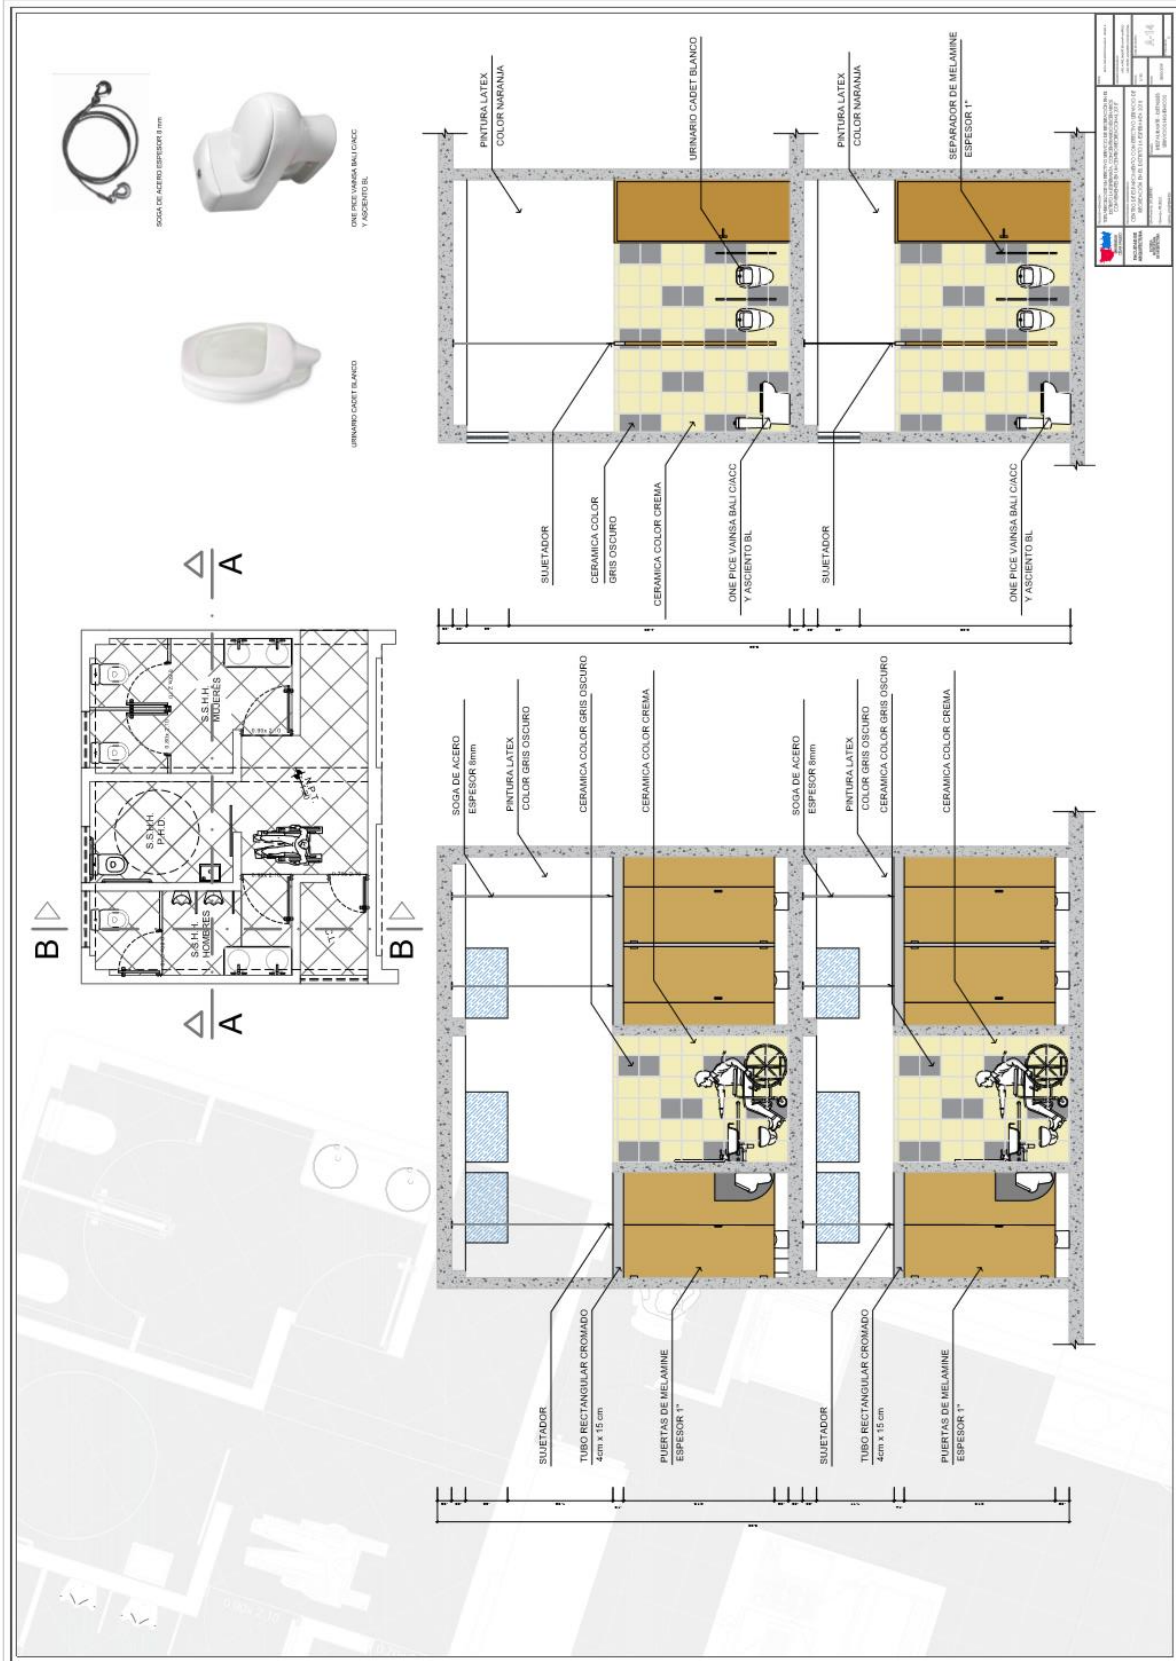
Plano de Detalles Servicios Higiénicos. Elaboración propia.
